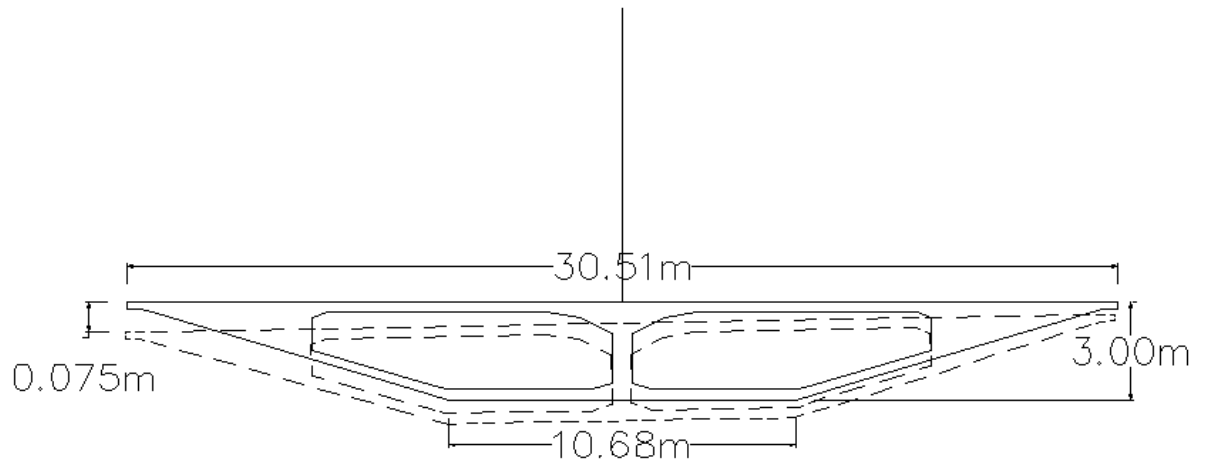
Sección transversal Bicelular-Central Deformada. Fuente: Autores
